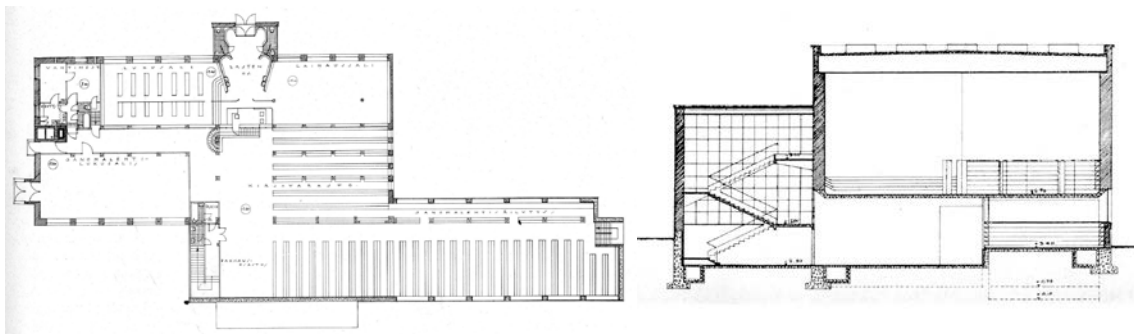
Biblioteca de Viipuri, planta de acceso y corte
